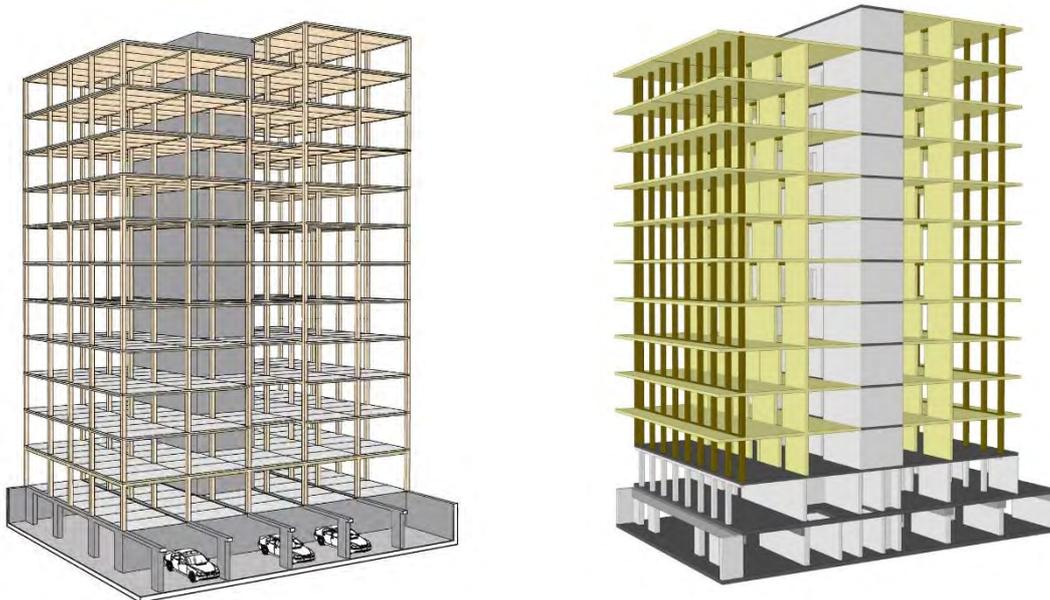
ursprüngliche Planung (li.); abgeänderte Planung (re.)
